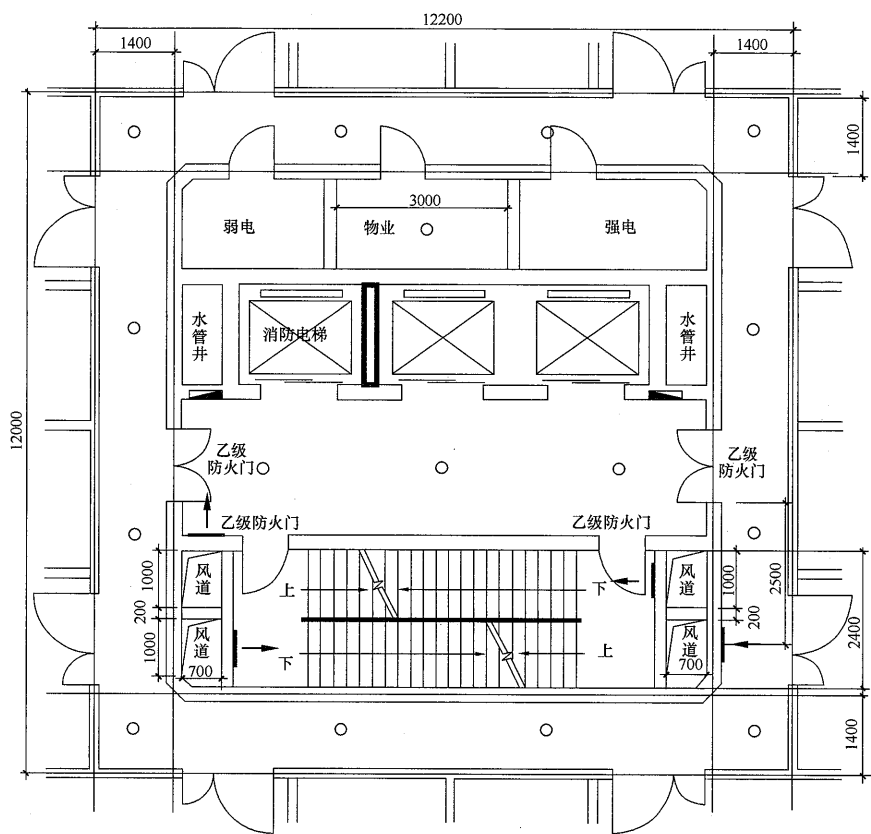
(b) 24 层高级公寓标准层平面图 (参考答案)
